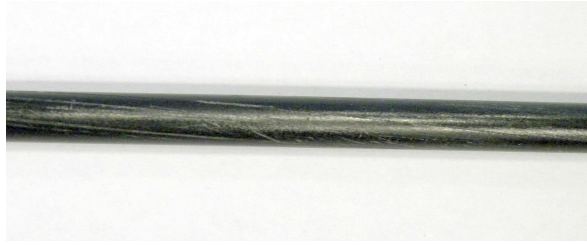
Mode de rupture en torsion pure : fissuration longitudinale
